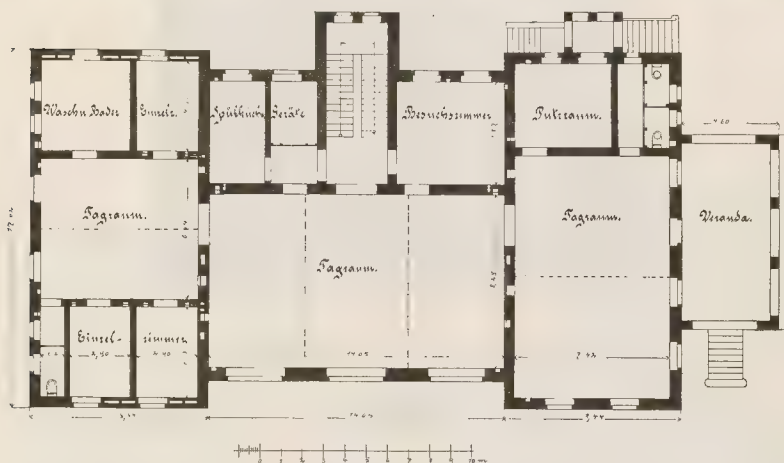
Grundriss des Erdgeschosses.
